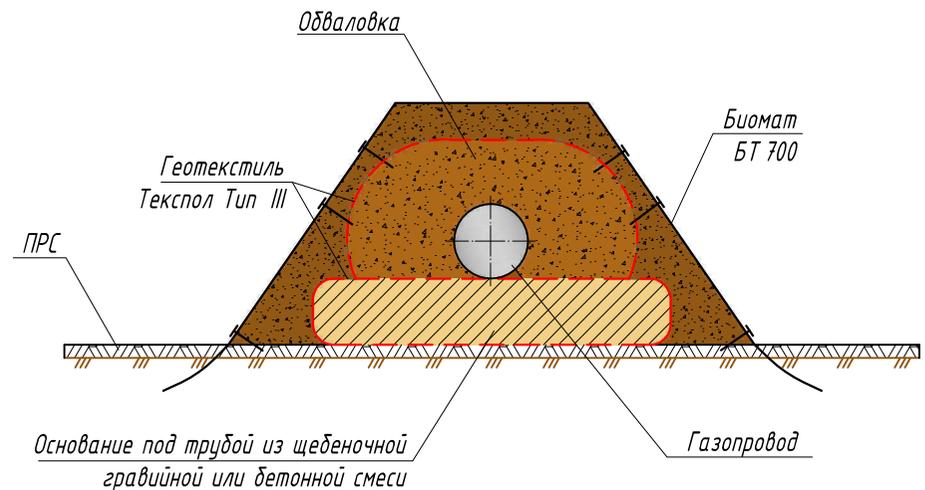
Защита биоматами грунтов обваловок газопроводов наземной прокладки, армированных геотекстильными материалами
